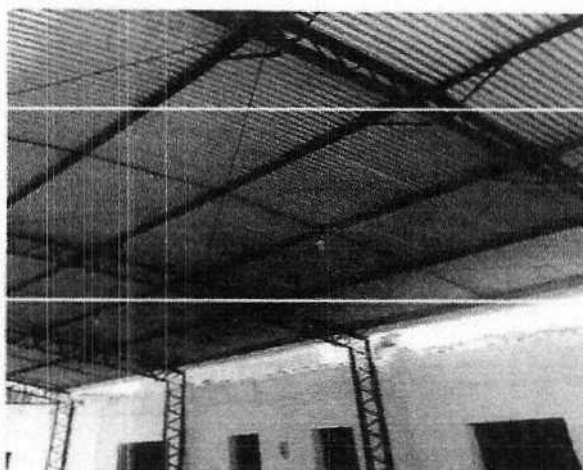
Coberta metálica do galpão com elevado processo corrosivo e instalações elétricas executadas de maneira inadequada
